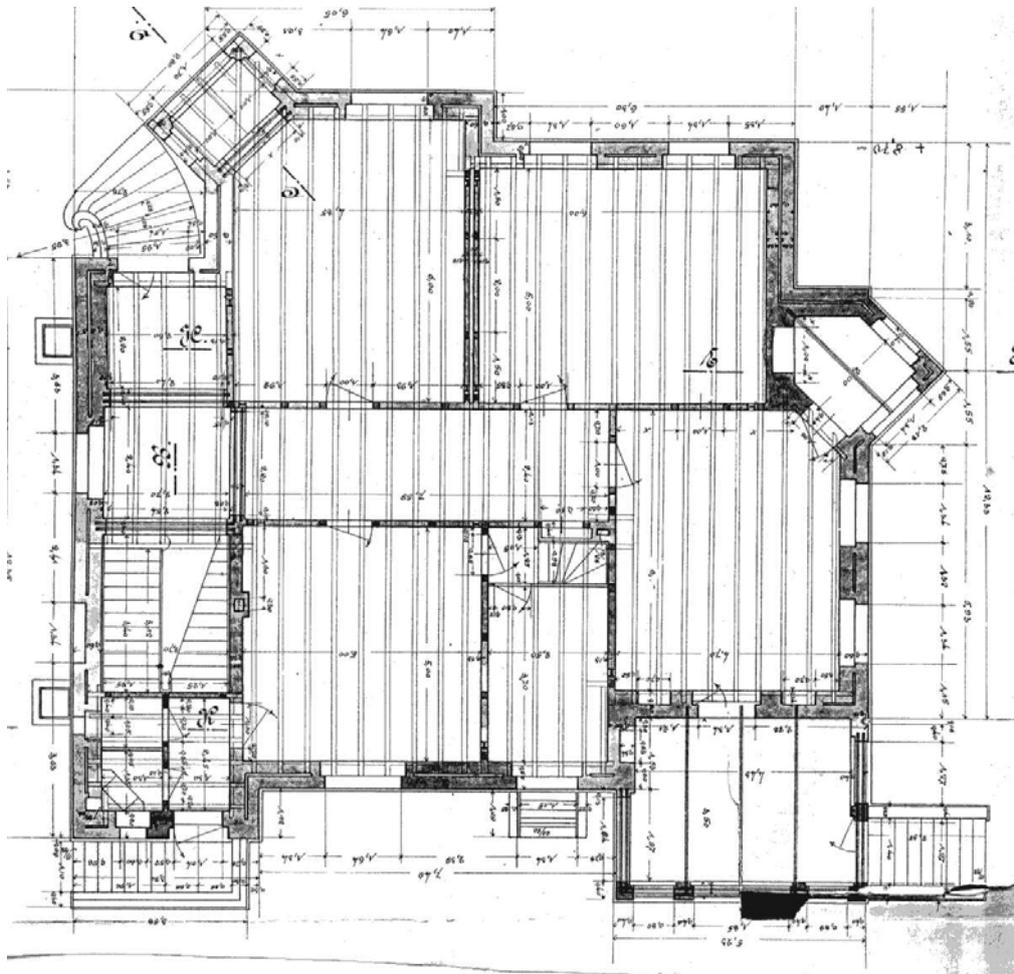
H. Plange, Grundriss Erdgeschoss, 1889
